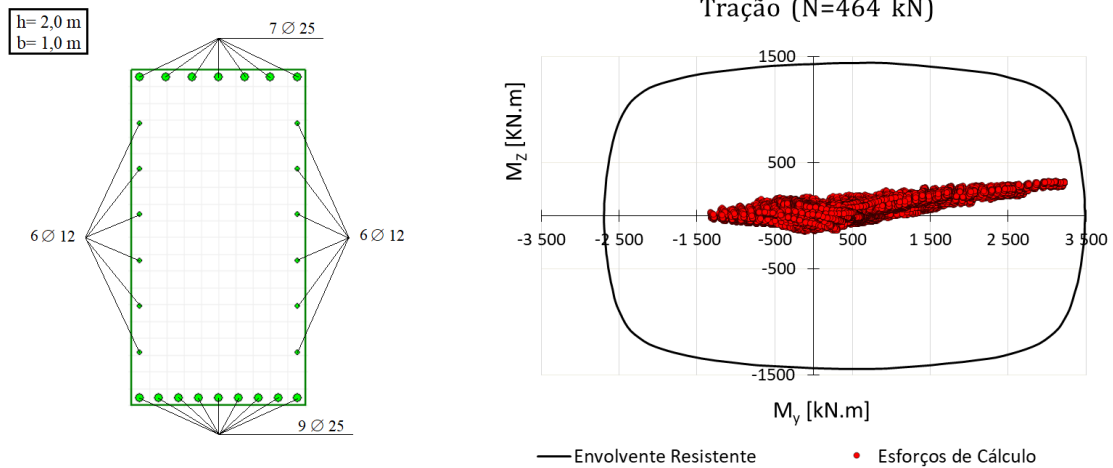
Armaduras longitudinais na viga V3B e respetivo ábaco de dimensionamento.
